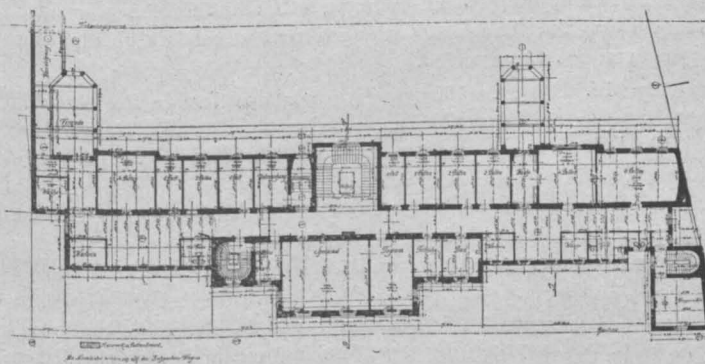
Hochparterre-Grundriß des Krankenpavillons (I. Entwurf).
